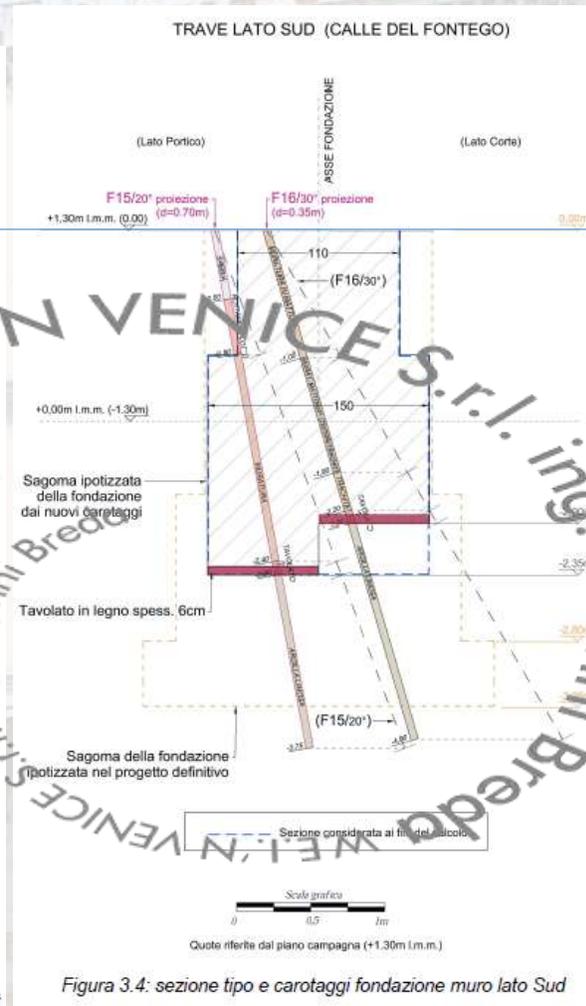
sezione tipo e carotaggi fondazione muro lato Sud
